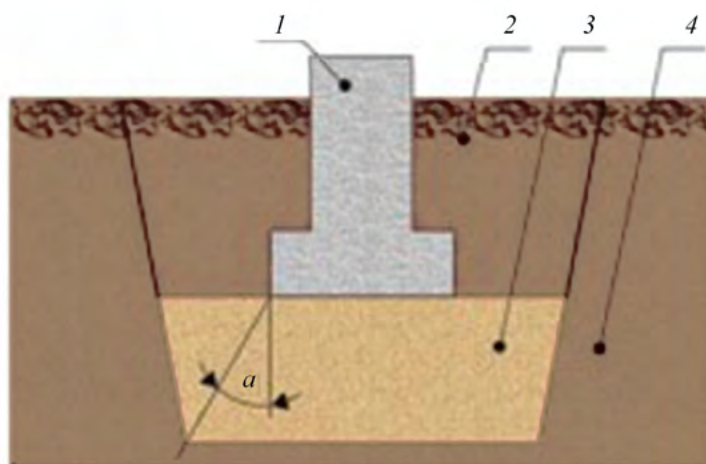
Схематичное изображение устройства песчаной подушки под фундаментом: 1 — фундамент; 2 — обратная засыпка; 3 — песчаная подушка; 4 — слой слабого грунта
